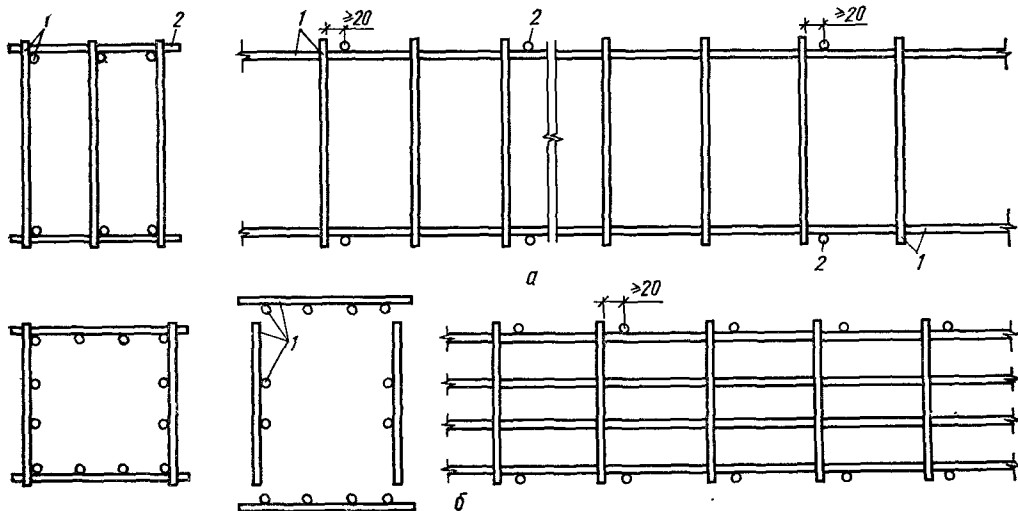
Арматурные каркасы, образованные из плоских сеток контактной точечной сваркой:
